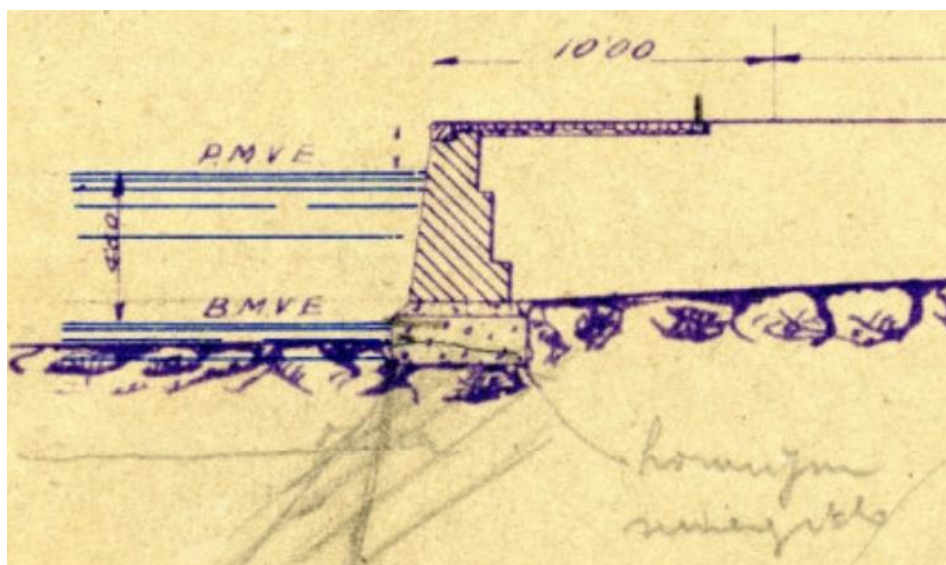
Sección del dique. Tipología de bloques con banquetta de hormigón sumergido. (Archivo Puerto Getaria).
